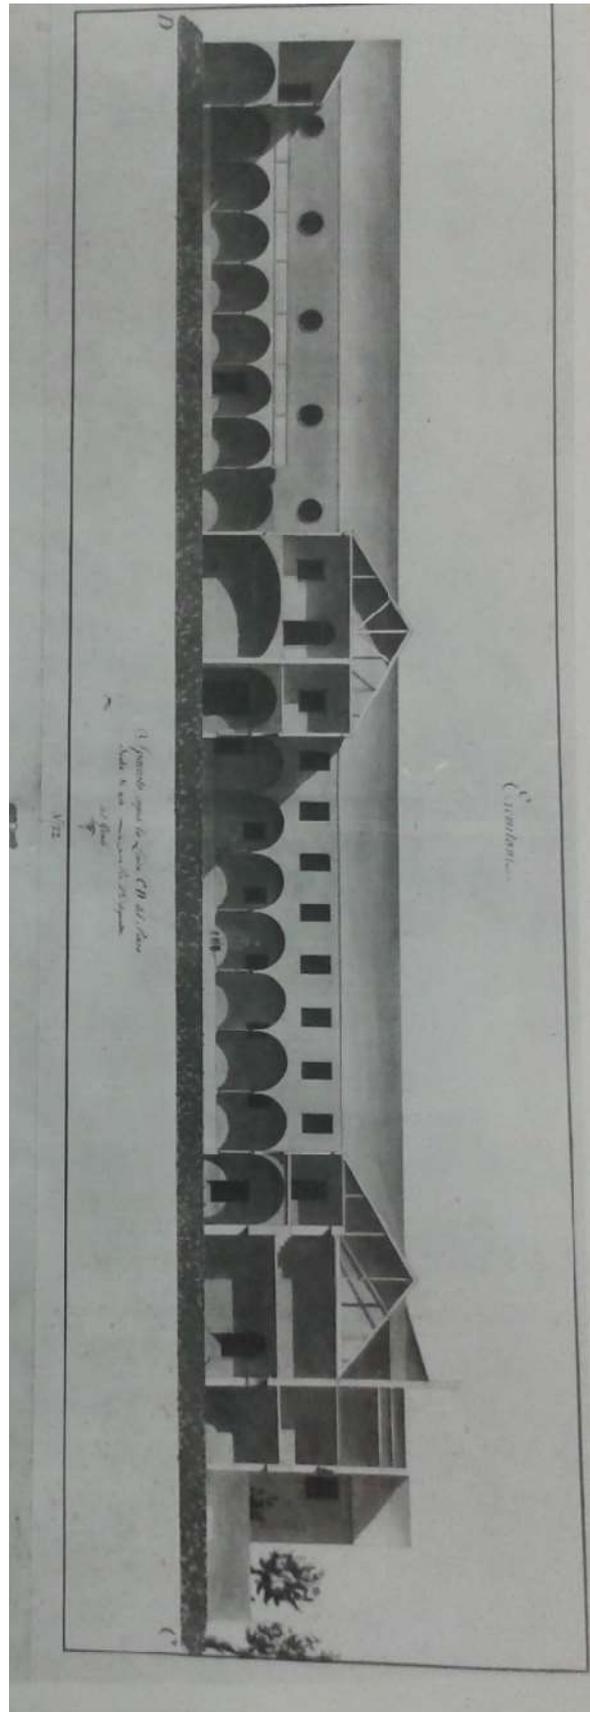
Sezione storica centro San Gaetano Padova, Scheda con lo spaccato della sezione CD del convento degli Eremitani
